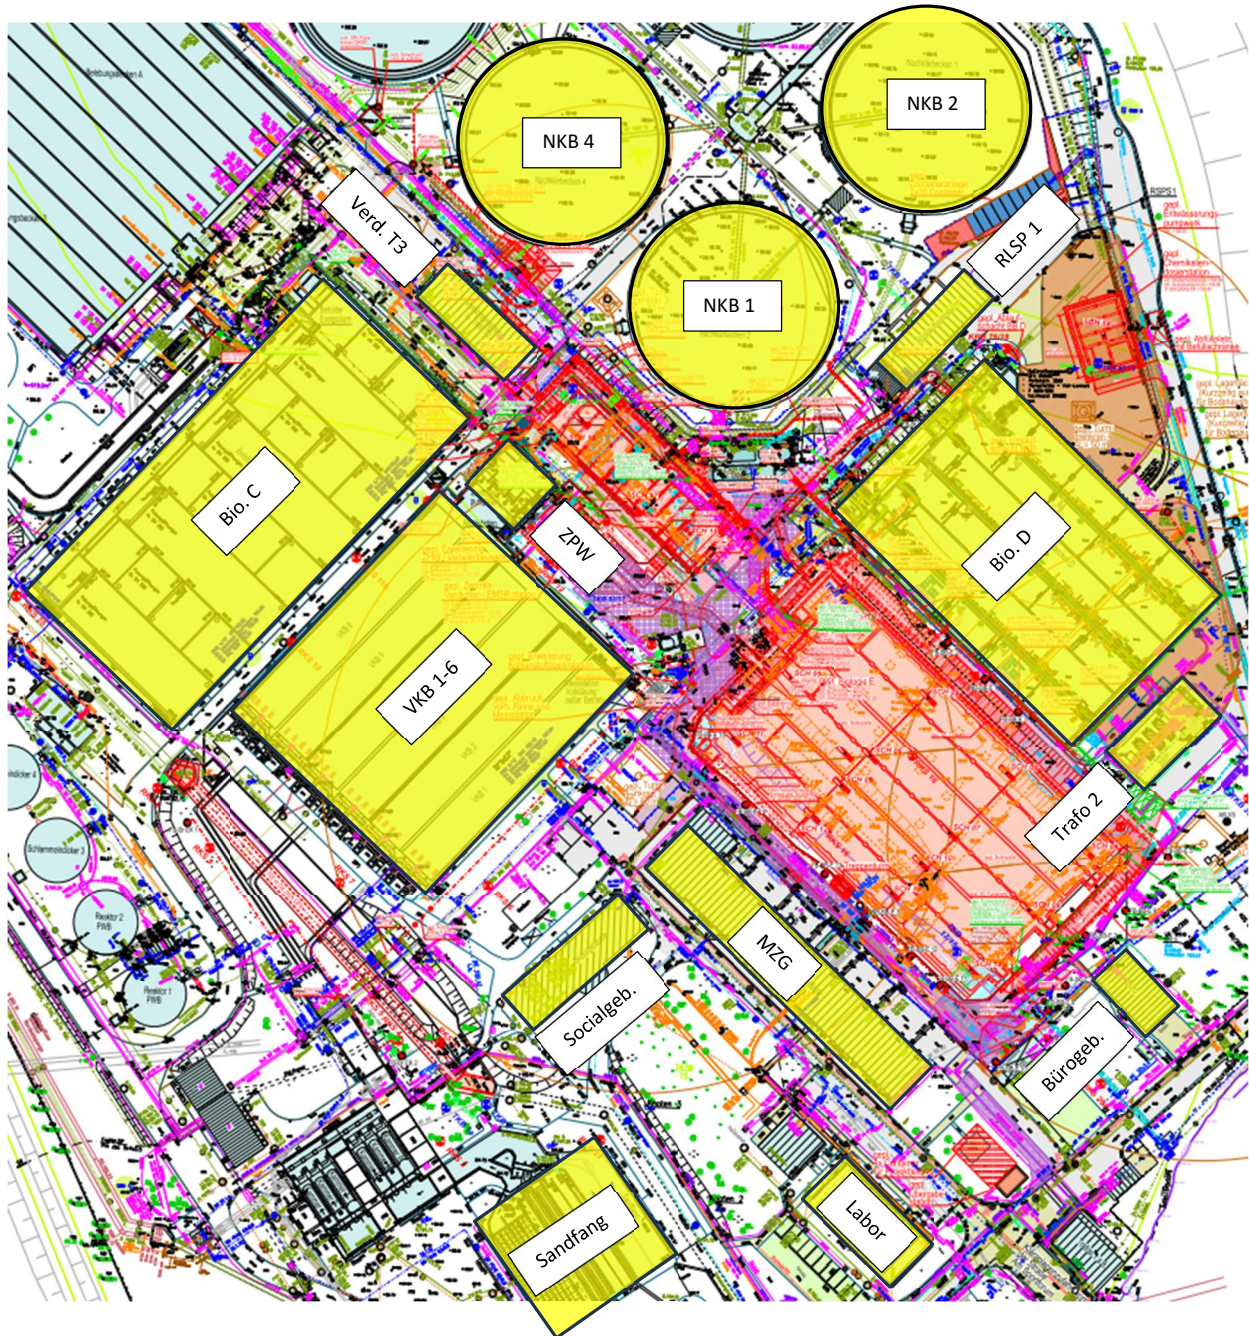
Lageplan der betrachtenden Bauwerke
